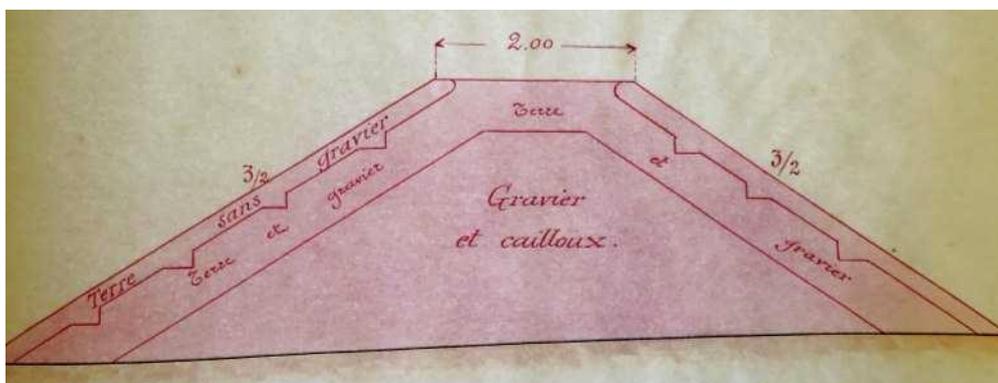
Profil type de la digue pour sa reconstruction, 1897 (AD 73 – 40SPC 28)
